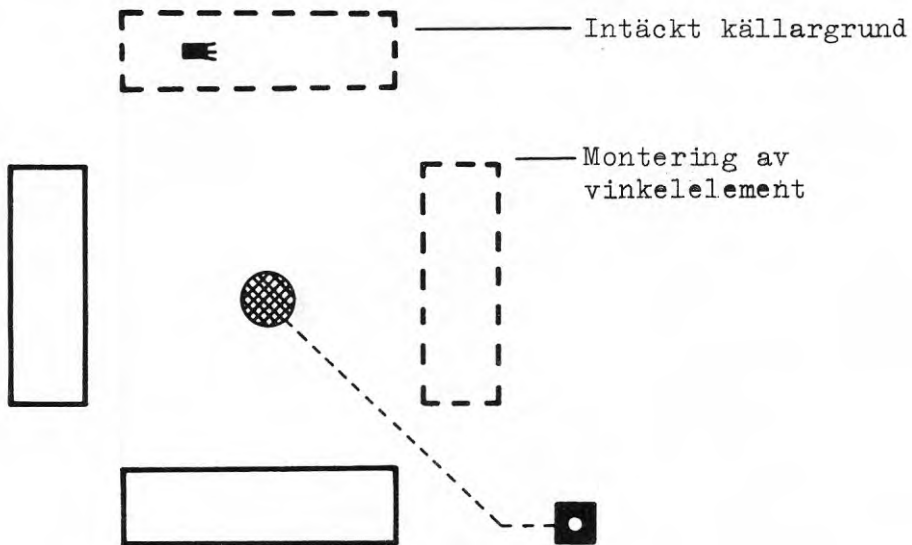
Objekt 37.1. Linköping. Situationsplan.
